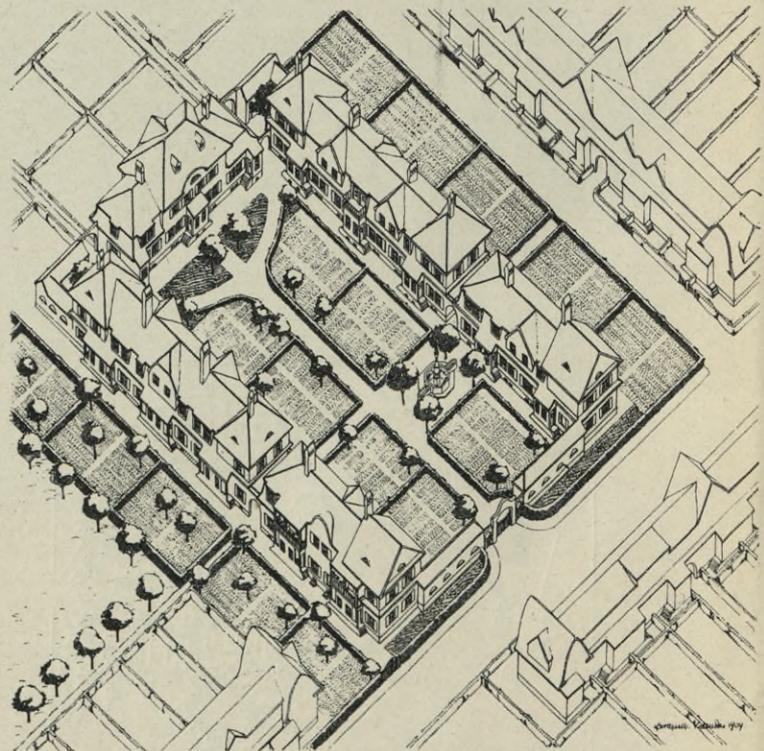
Gartenstadt Perlach. Wohnhof, mit 24 Einfamilienhäusern umbaut. Architekt Berlepsch Valendas, Planegg München
